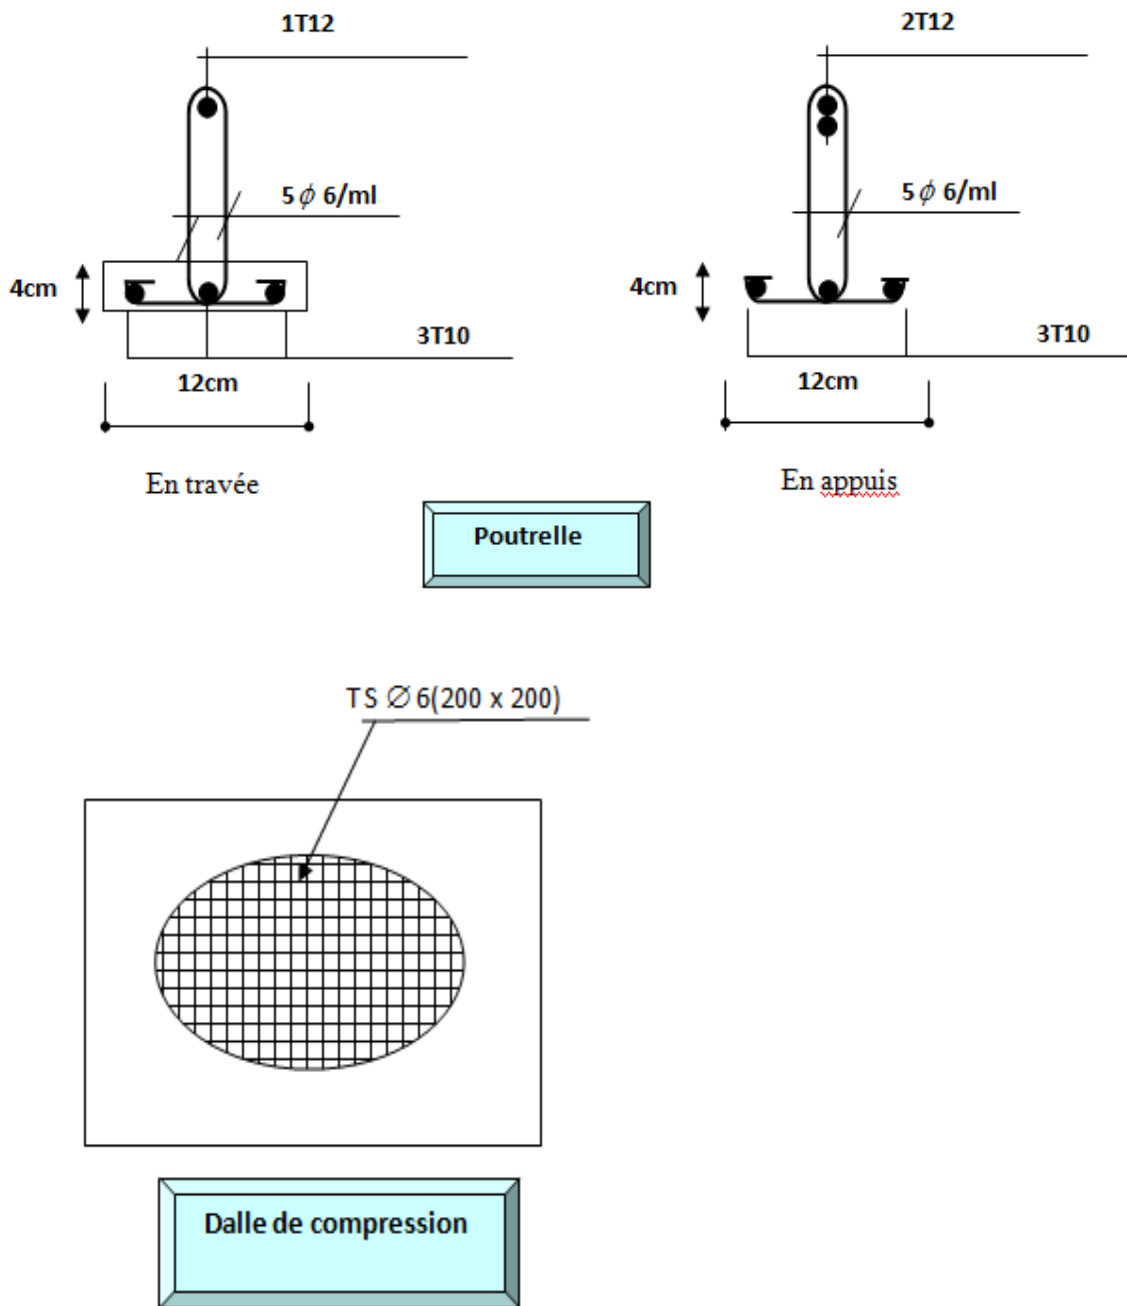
Schéma de ferrailage de Poutrelle et de Dalle de compression
